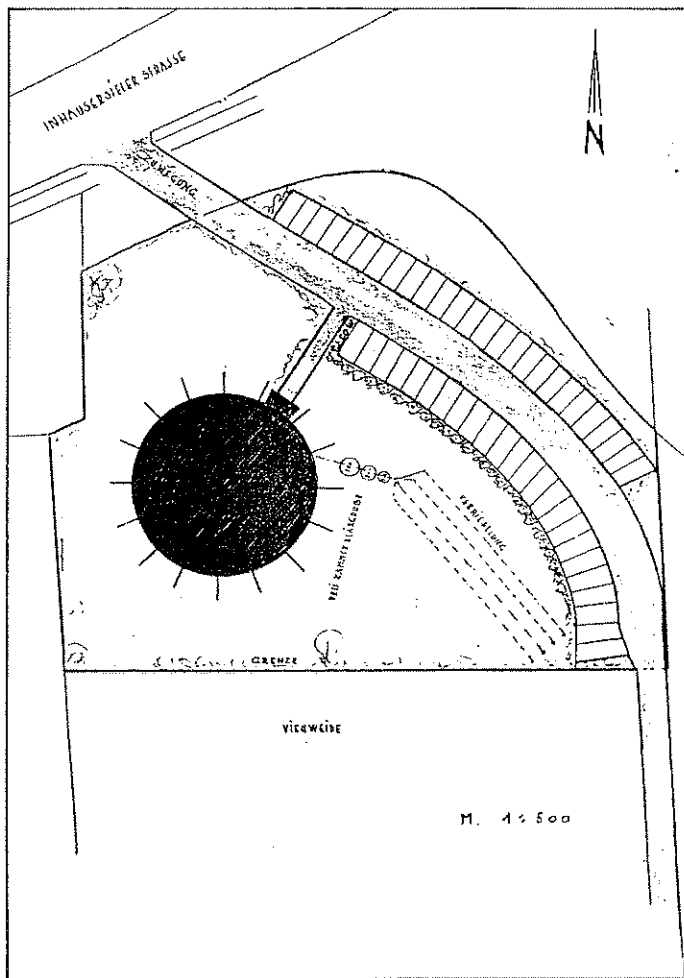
/2. Lageplan Infocenter beim »Jadewindpark«, Wilhelmshaven.
